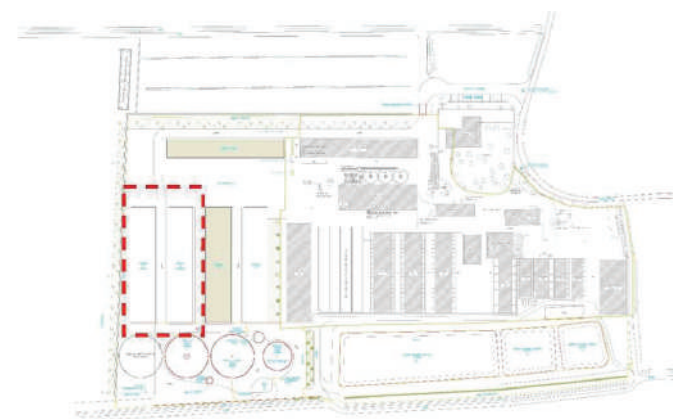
planimetria generale dell'area (all'interno del tratteggio rosso gli edifici in progetto)
